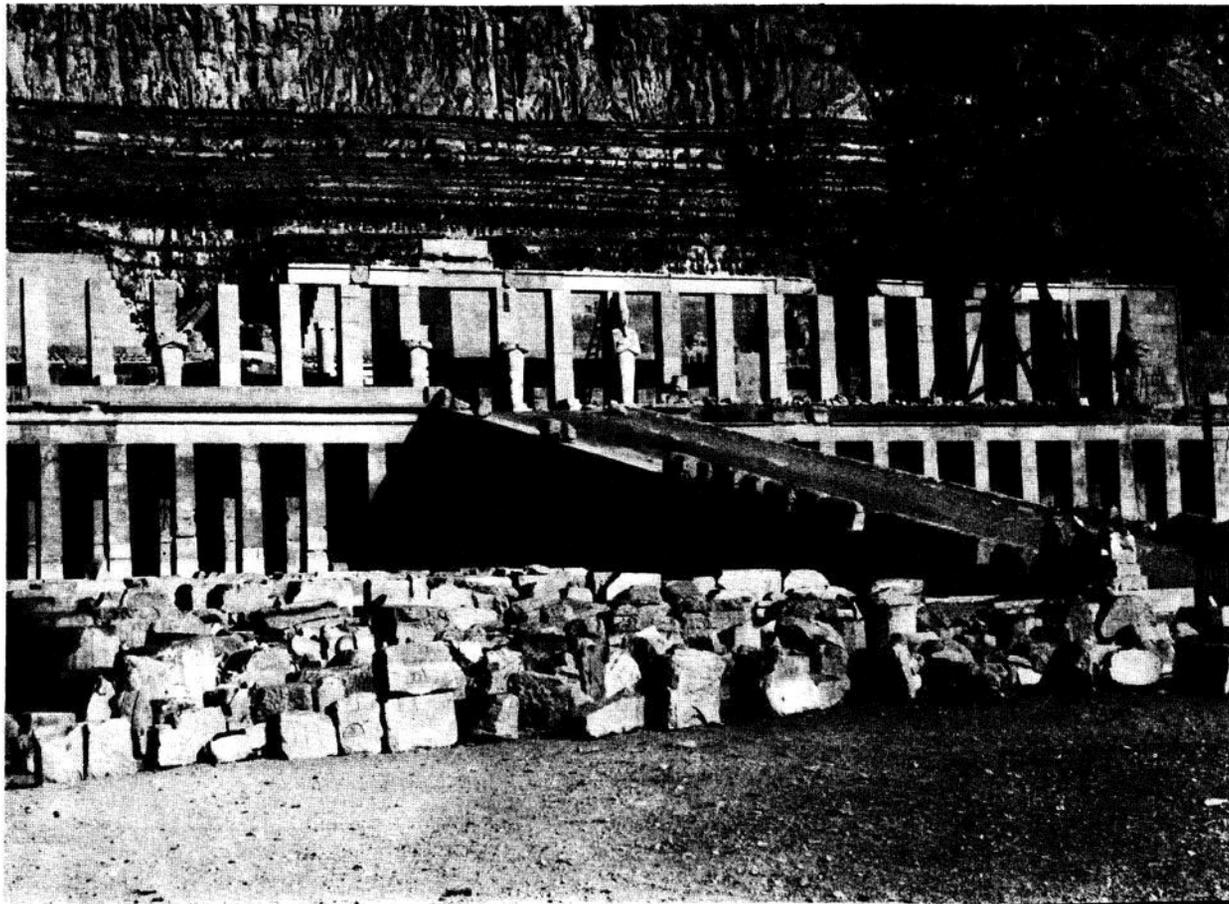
Deir el-Bahari. Travaux de la mission polonaise au temple d'Hatshepsout. Remontage d'architraves sur les piliers du portique supérieur et du mur de soutènement à l'arrière
